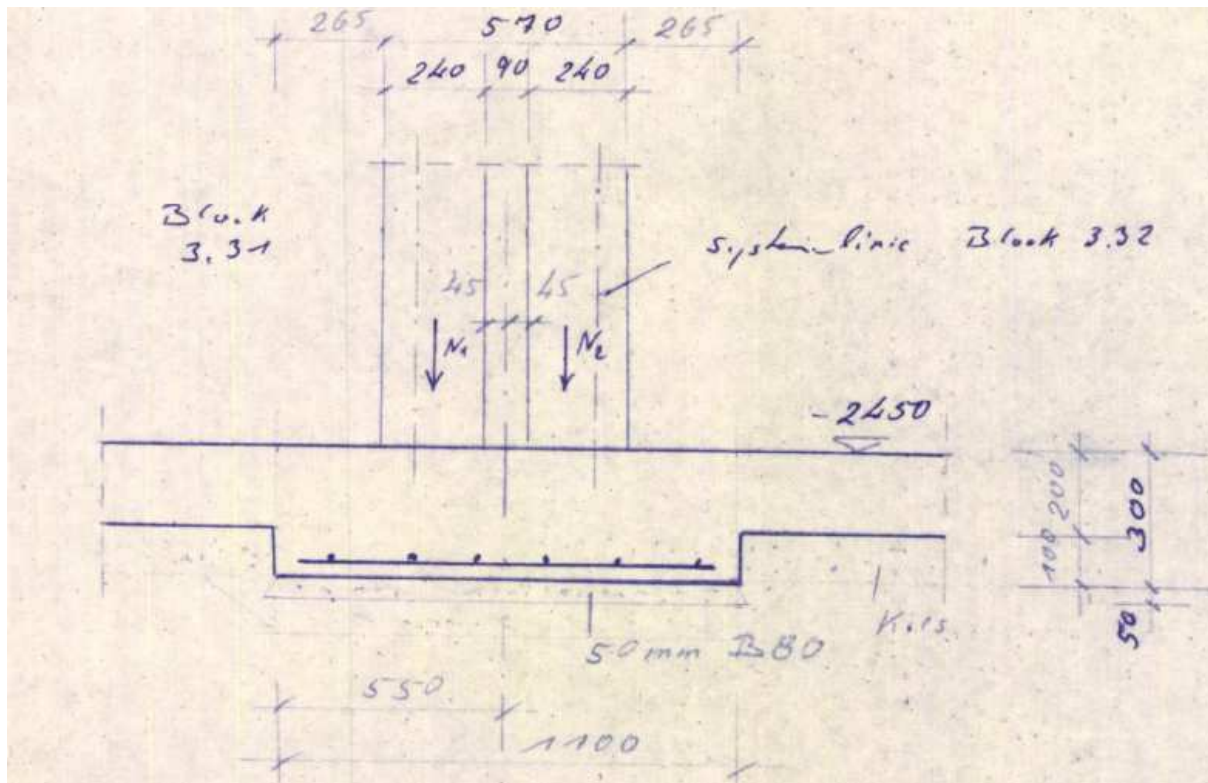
Systemschnitt aus /U.5/ mit Bewehrungsstreifen und Verstärkung der Gründungsplatte unter tragenden Wandachsen
